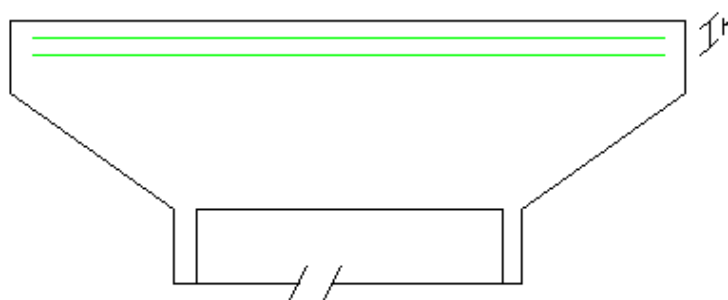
Pormenor armadura capitel para as cargas verticais
